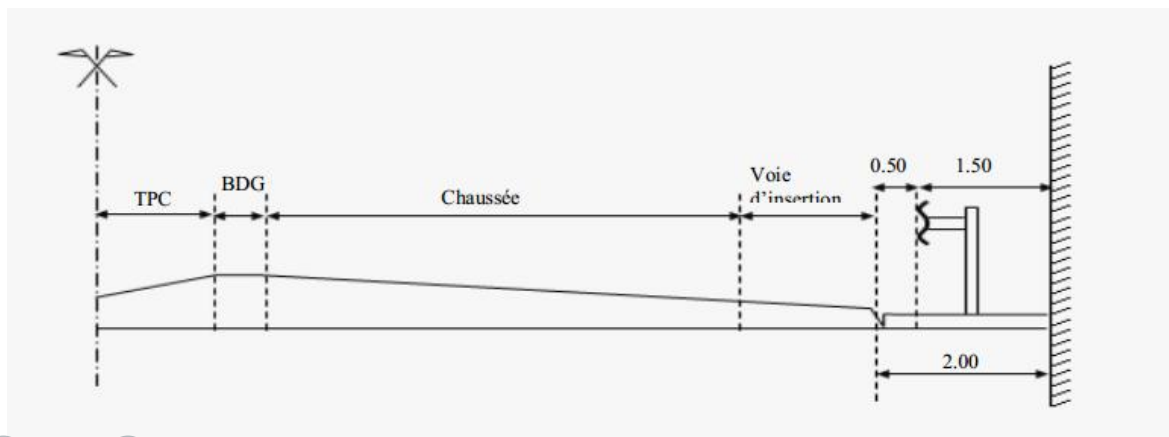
Profil en travers sous l'ouvrage d'art.
